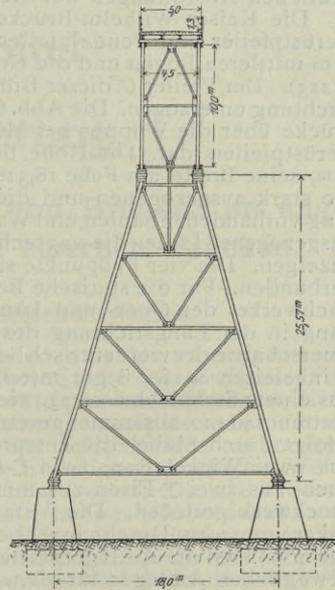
Pendeljoch-Querschnitt zu Abb. 614.
